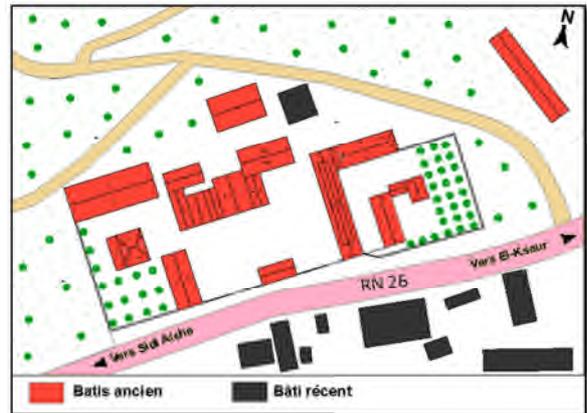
Plan d'ensemble de la ferme Benyoub maten. Elkseur
